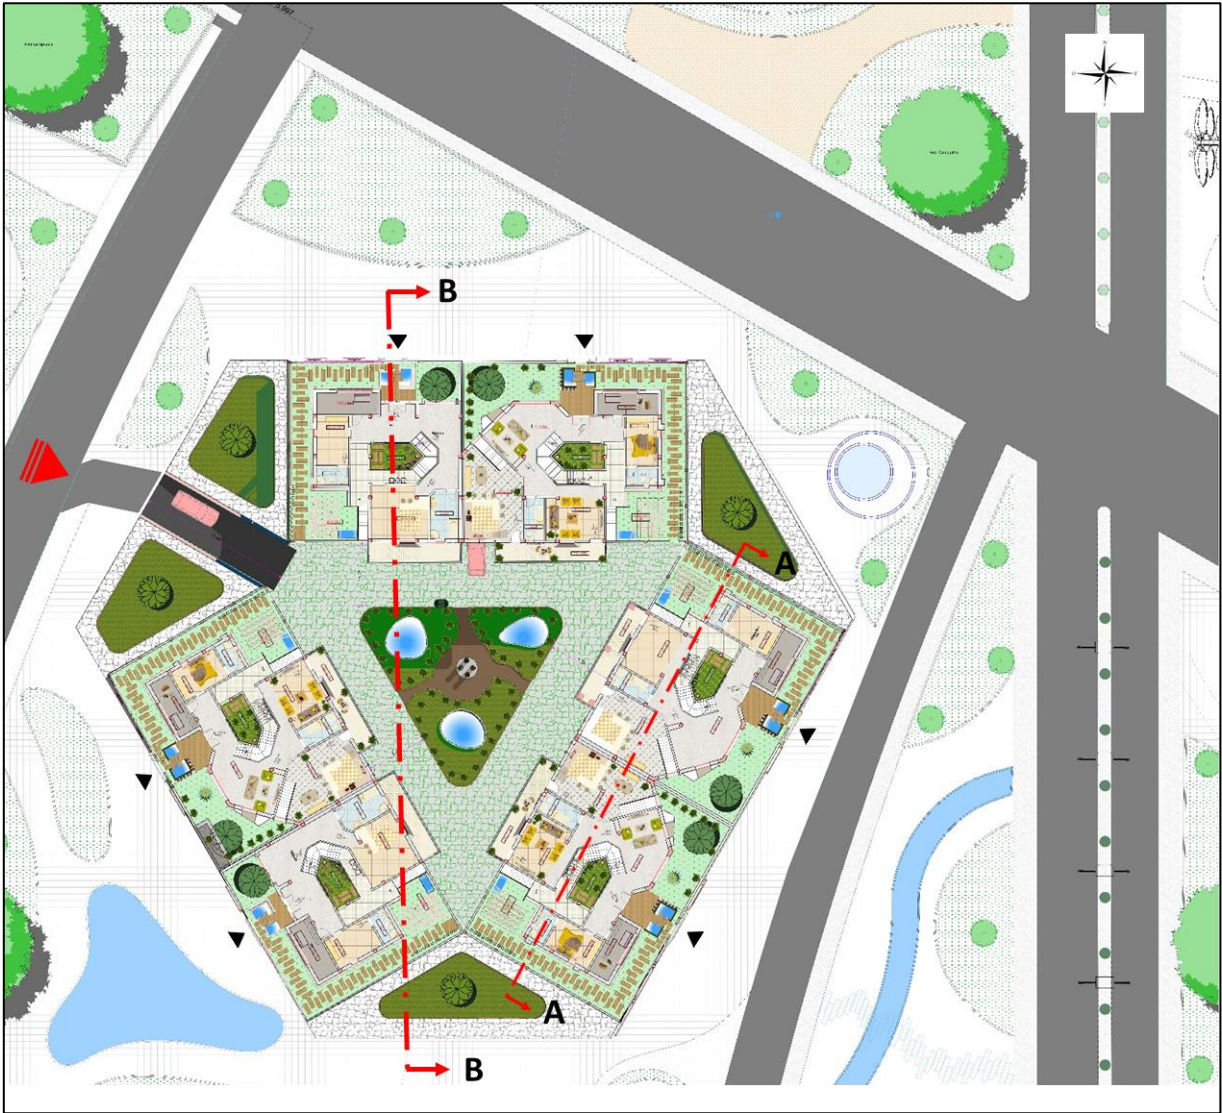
Plan d'assemblage d'un groupement (F5*4/F4*2) ech 1/500.
